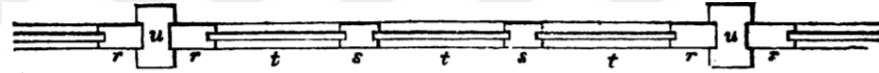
Dikmeler ile temel kirişlerinin birleşim planı (Loudon, 1846)
